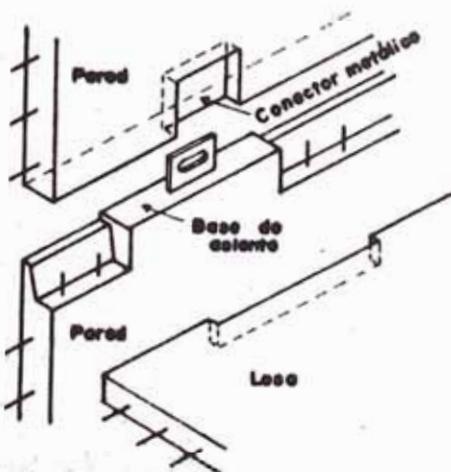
(b) Junta Horizontal de Paredes Portantes
